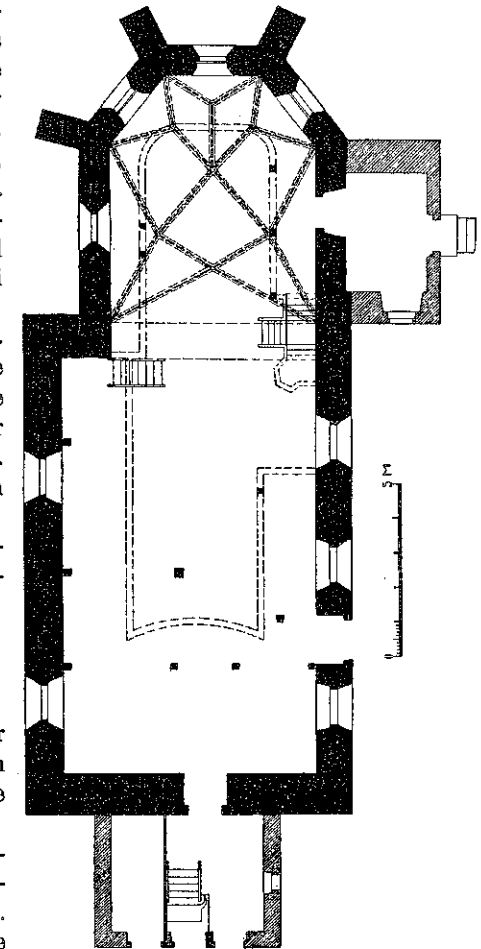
Arnsdorf, Grundriss der Kirche.
